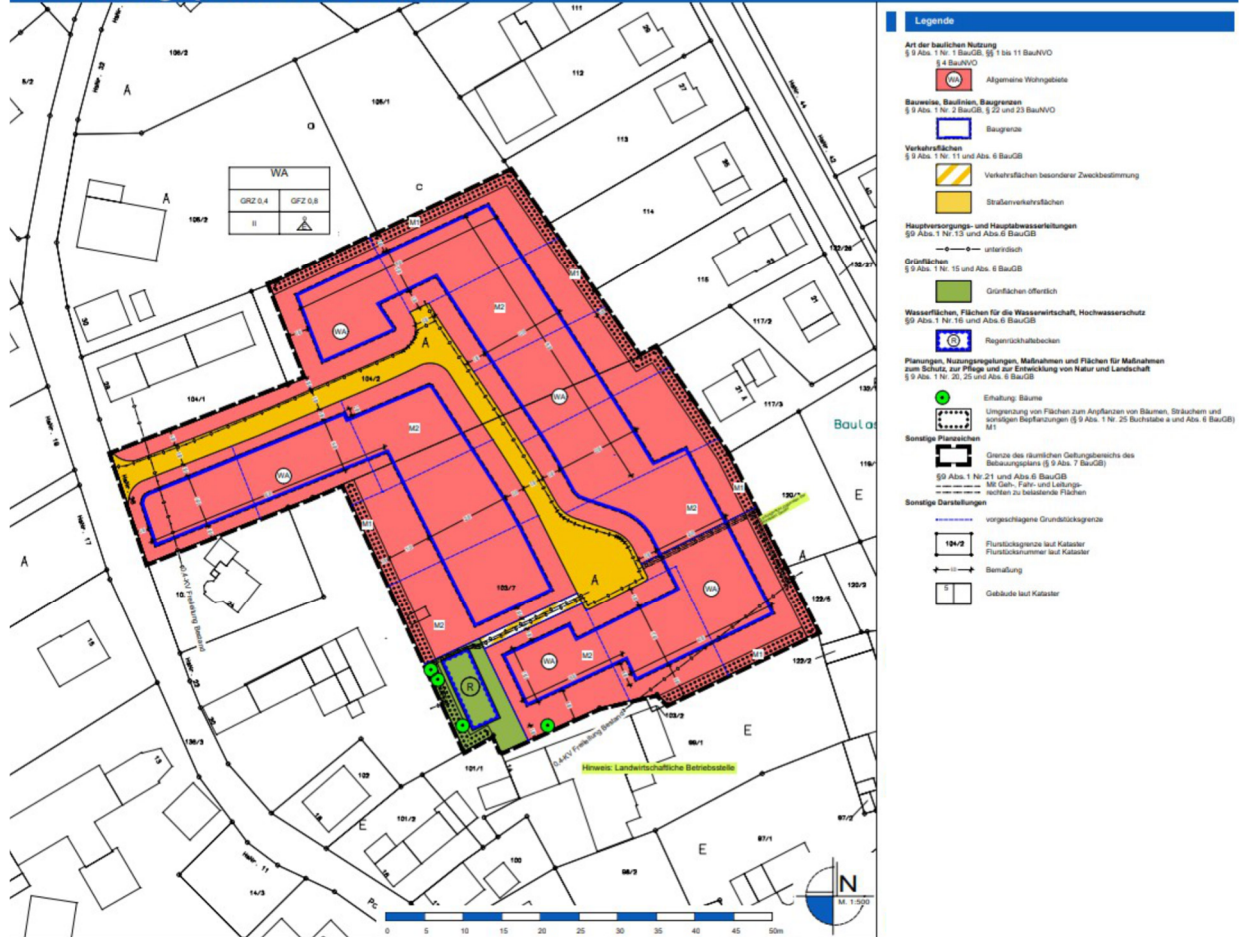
Bebauungsplan (WeSt-Stadtplaner, Januar 2025)
